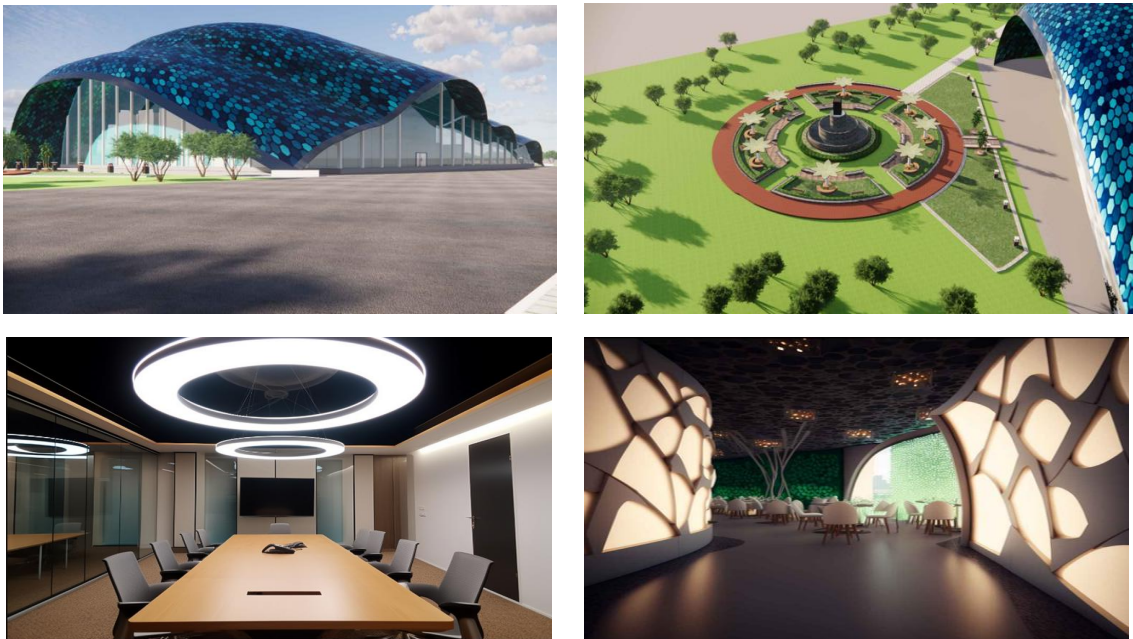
Tampak Bangunan Dengan Urutan Dari Atas Ke Bawah :
